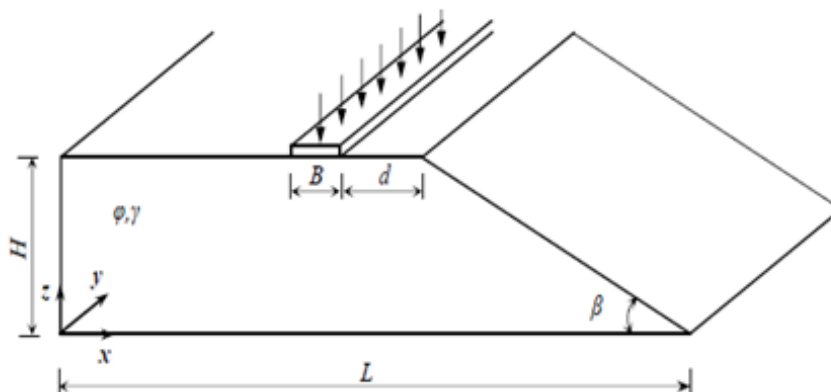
Fondation a proximité d'une pente (Mabrouki et al 2010)
